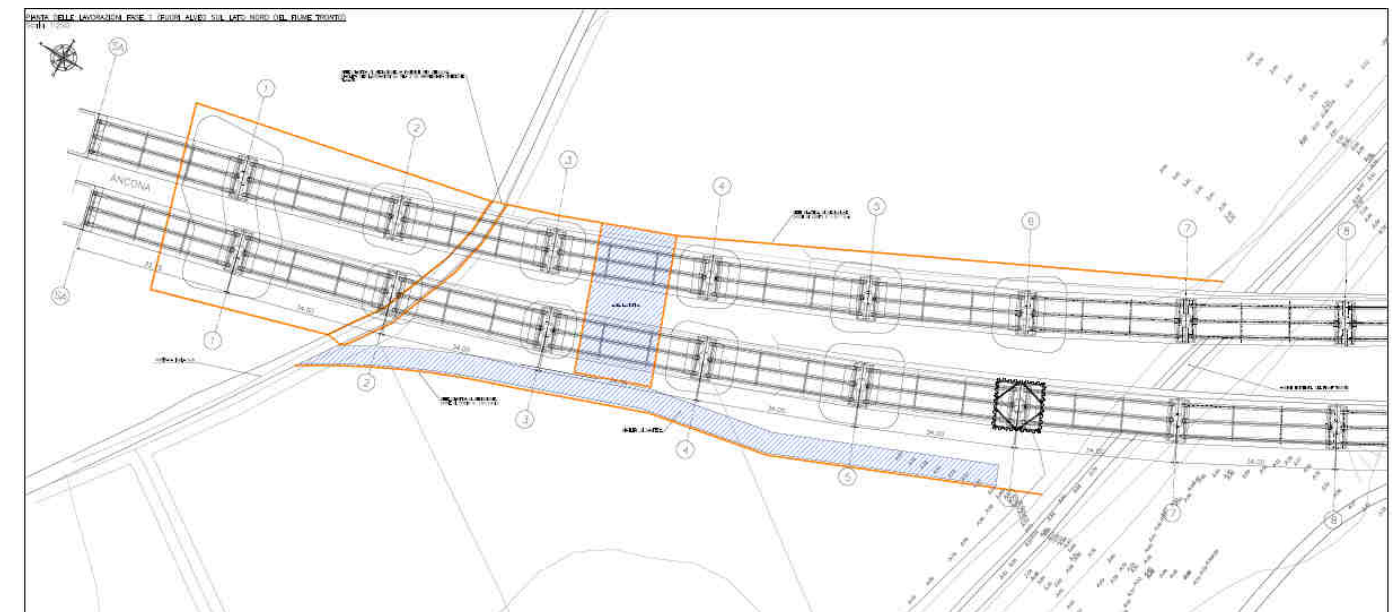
stralcio di cantierizzazione con indicazione degli accessi per la riparazione delle pile da 1 a 6.
